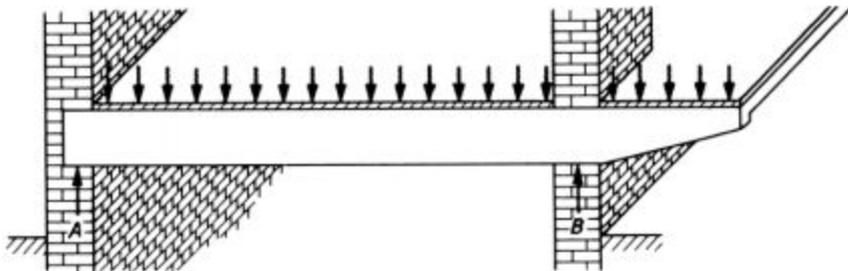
Der Stahlbetonbalken unter Decke und Laderampe ist ein Balken mit Kragarm.
